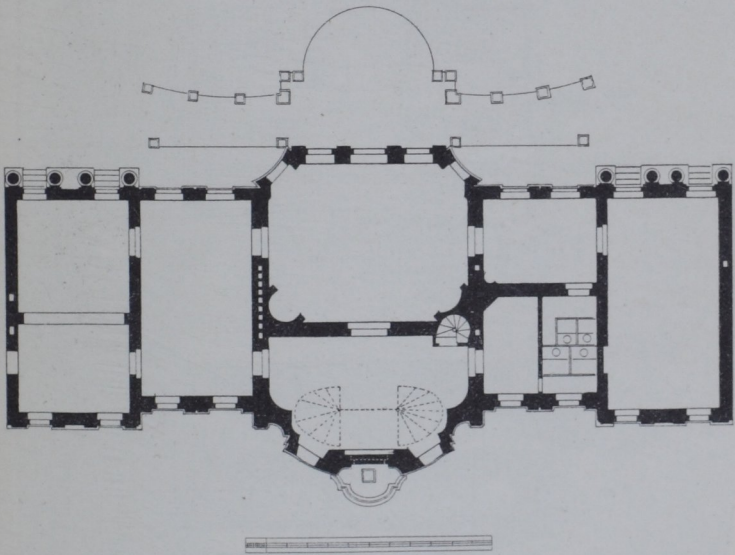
Kameke'sches Gartenhaus zu Berlin. Grundriß.
